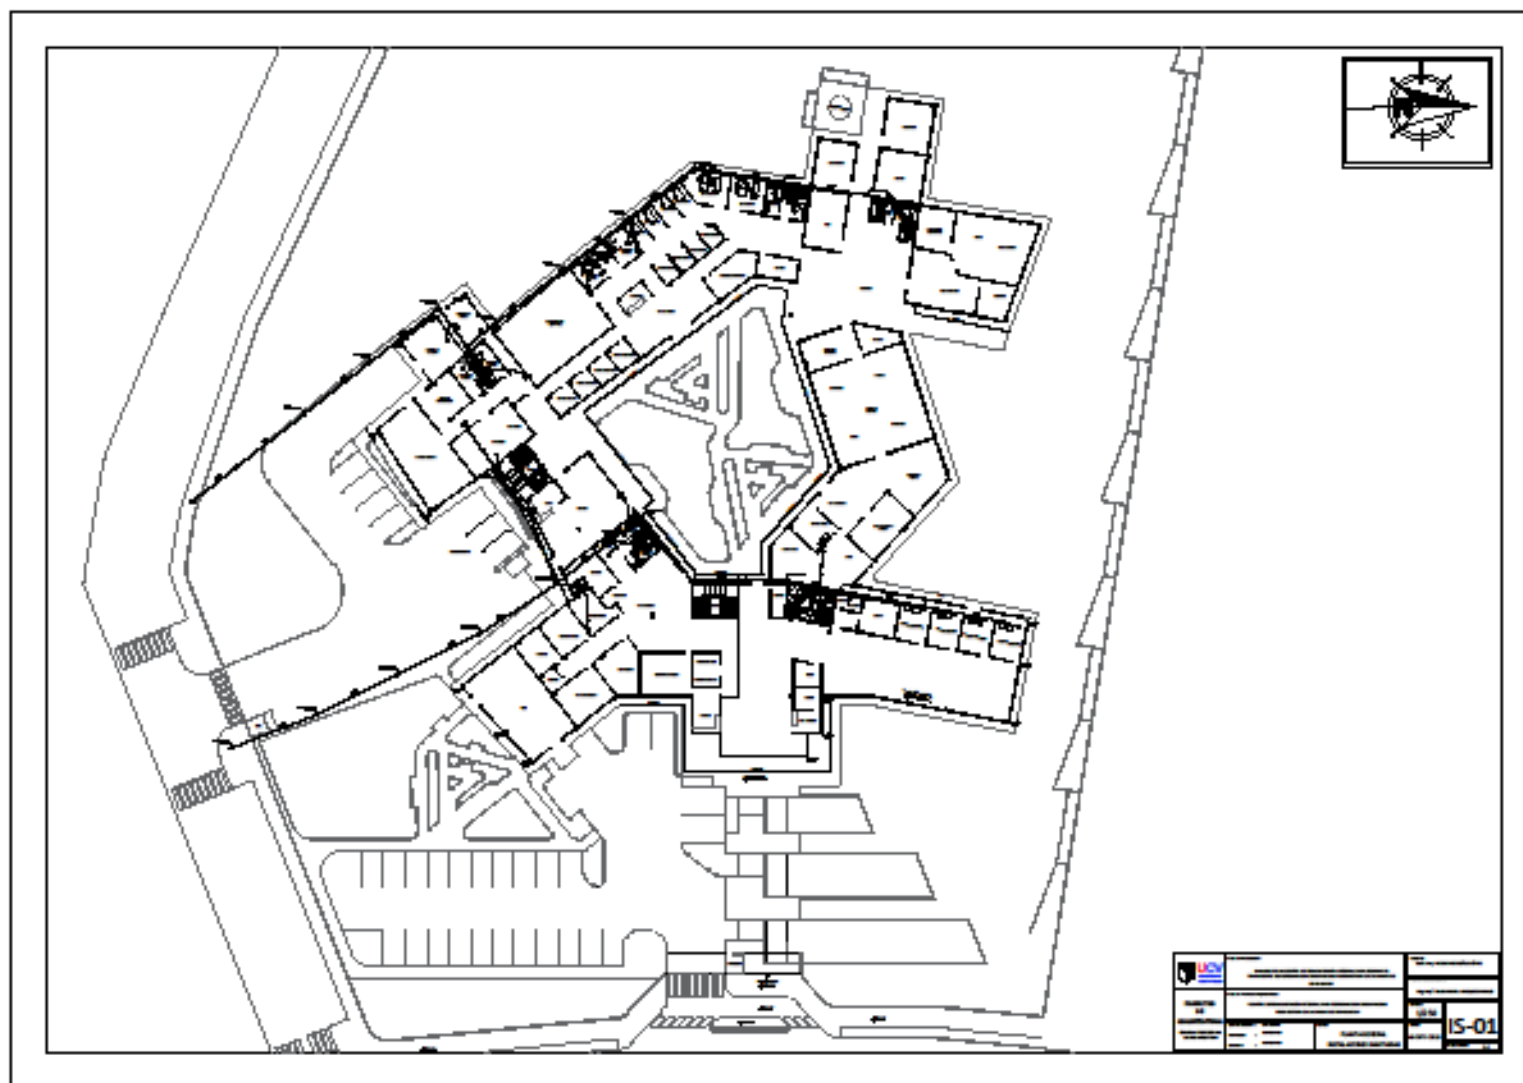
Planos de Instalaciones sanitarias – desagüe 2do piso
